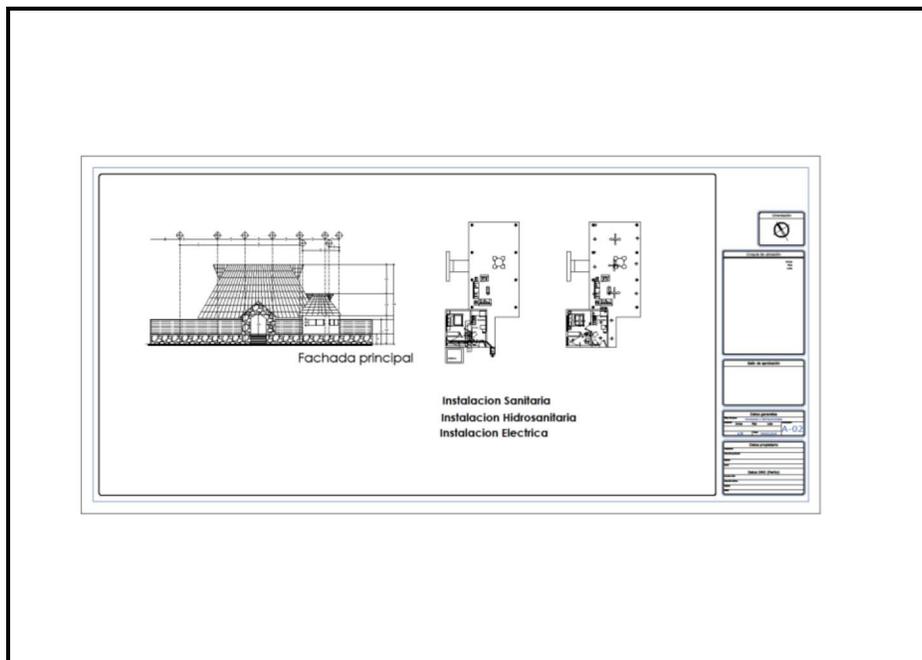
Proyecto “Casa Habitación Soliman”. Fachada principal.
